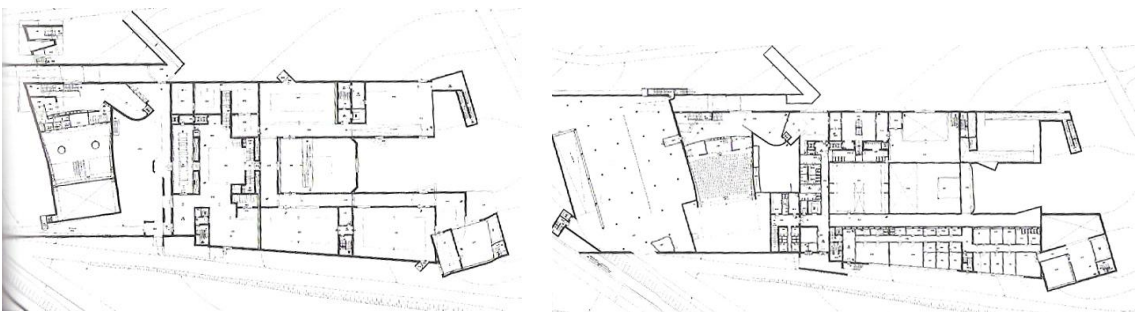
| Museu Serralvez - Planta inferior Fig. 87 | Museu Serralvez - Planta superior | JODIDIO
